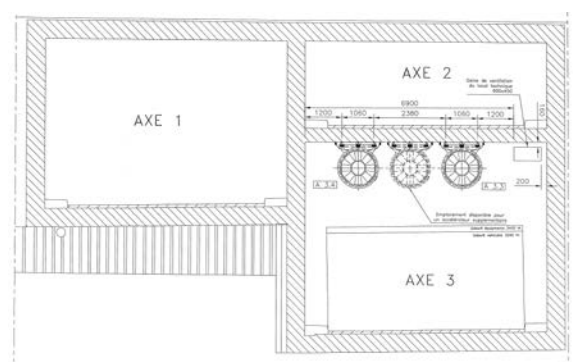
Profil en travers type au droit de l'accès aux parkings souterrains
